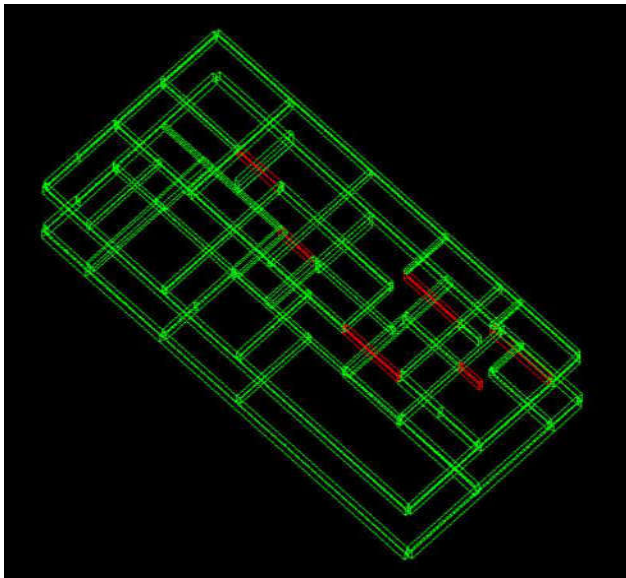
SLV 70% - verifiche travi II° e III° solaio
